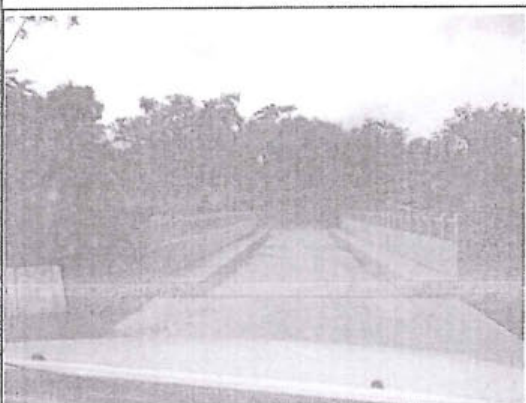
Puente de Concreto, en servicio. Con Plataforma, Veredas y Barandales en buen estado operativo.
